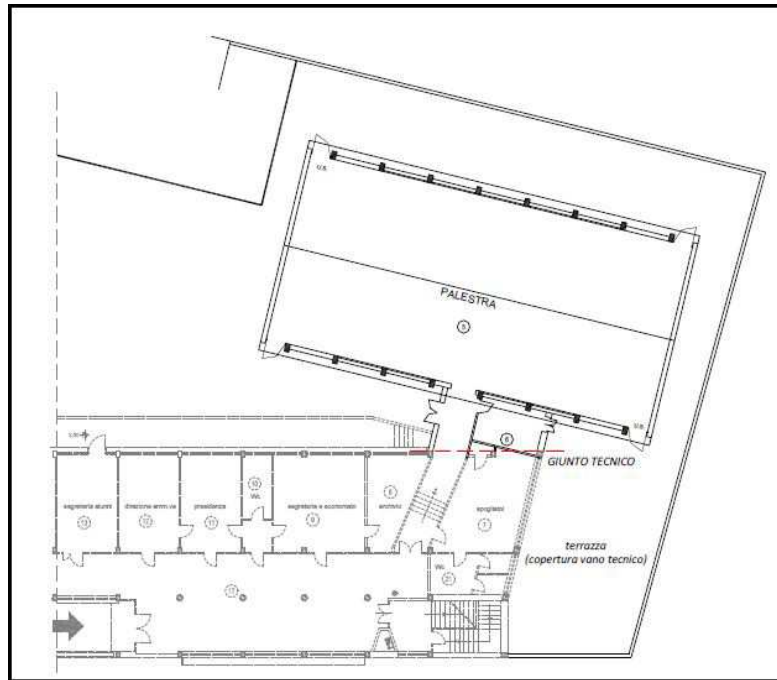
Pianta generale palestra con indicazione del giunto tecnico di separazione dal blocco aule
